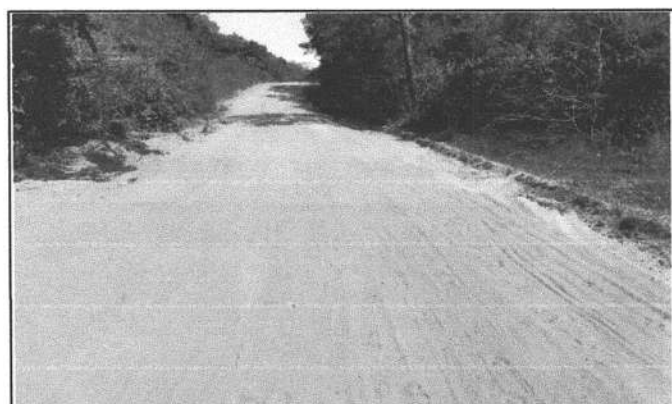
LOCAL DA CONSTRUÇÃO - BUEIRO
